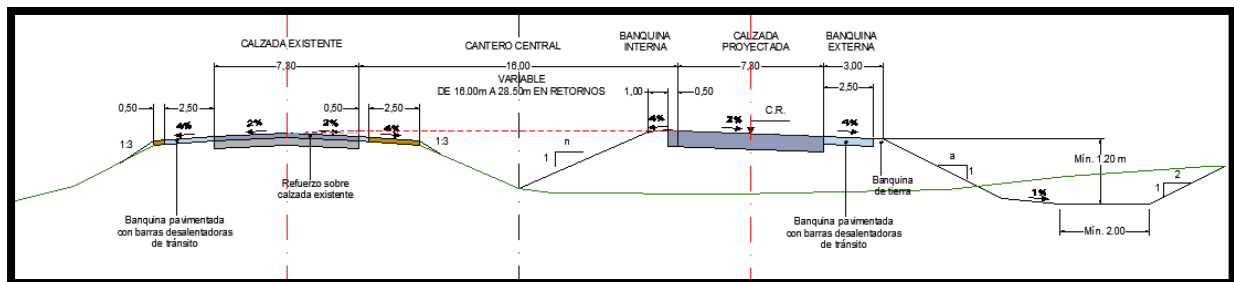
Perfil tipo N°1 de obra básica de proyecto.
